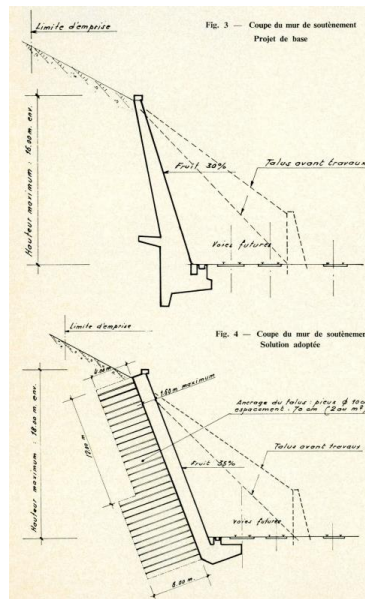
Extrait d'un article de la Revue générale des chemins de fer : « CONSTRUCTION D'UN MUR DE SOUTÈNEMENT ENTRE VERSAILLES-CHANTIERS ET VERSAILLES-MATELOTS en vue du sextuplement des voies nécessité par la desserte de la VILLE NOUVELLE et St-QUENTIN-en-YVELINES » par André RABEJAC et Paul TOUDIC, 1974
